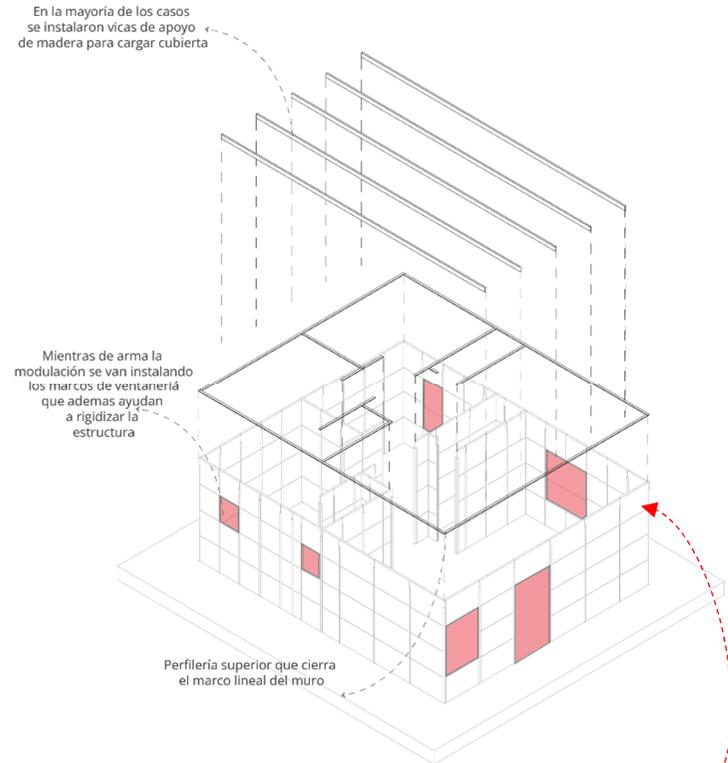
esquema montaje vivienda prefabricada con estructura de vigas y columnas metálicas
